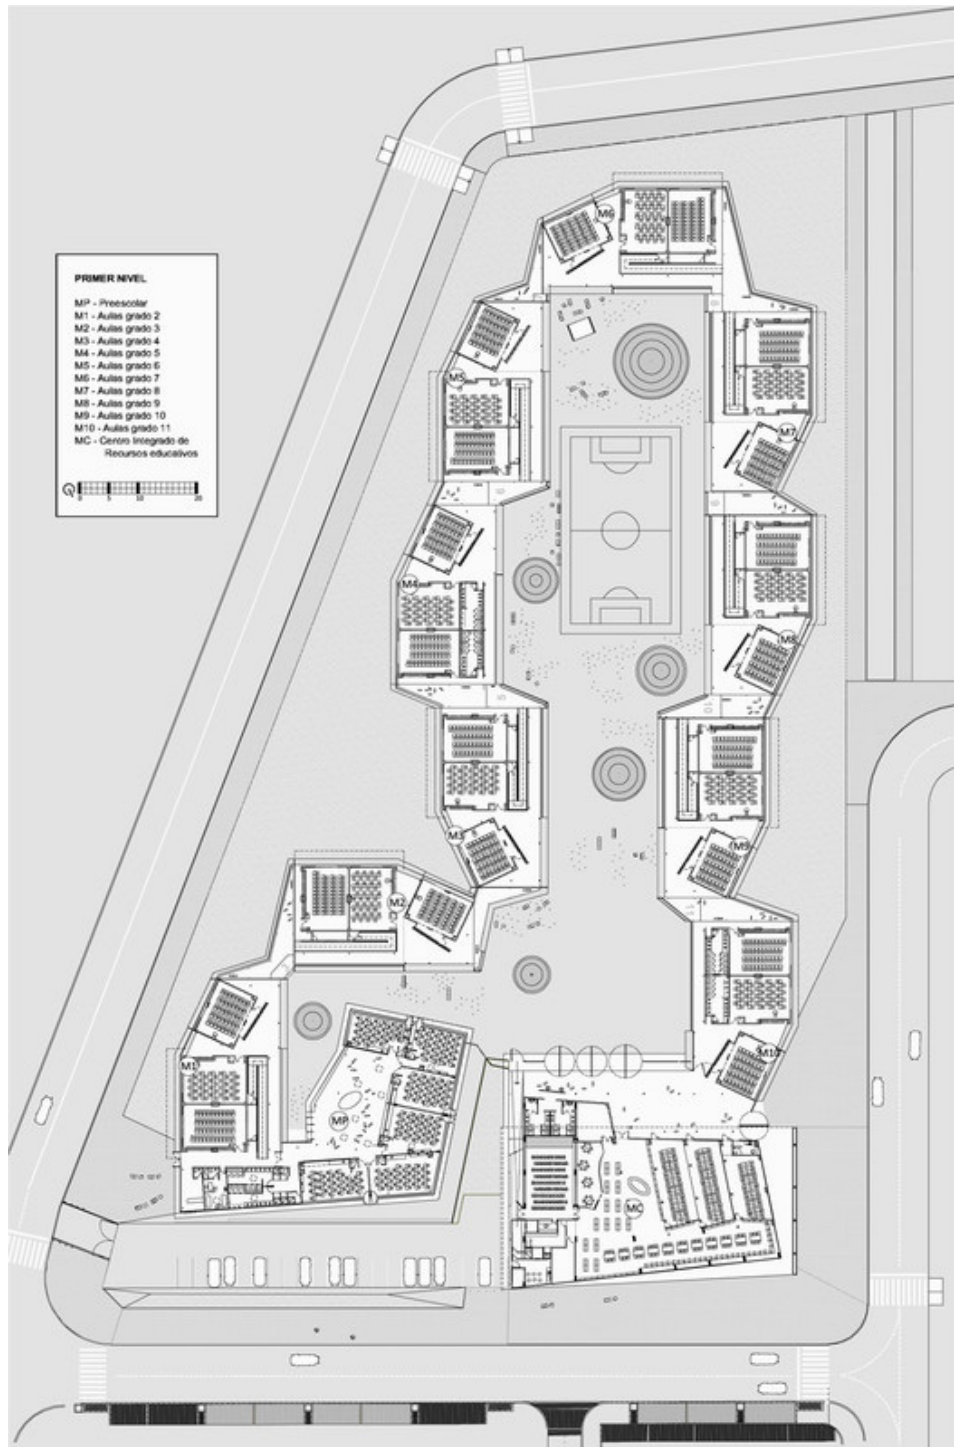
Planta baja Gerardo Molina. Fuente: <https://www.archdaily.com/8660/gerardo-molina-school-giancarlo-mazzanti>.
